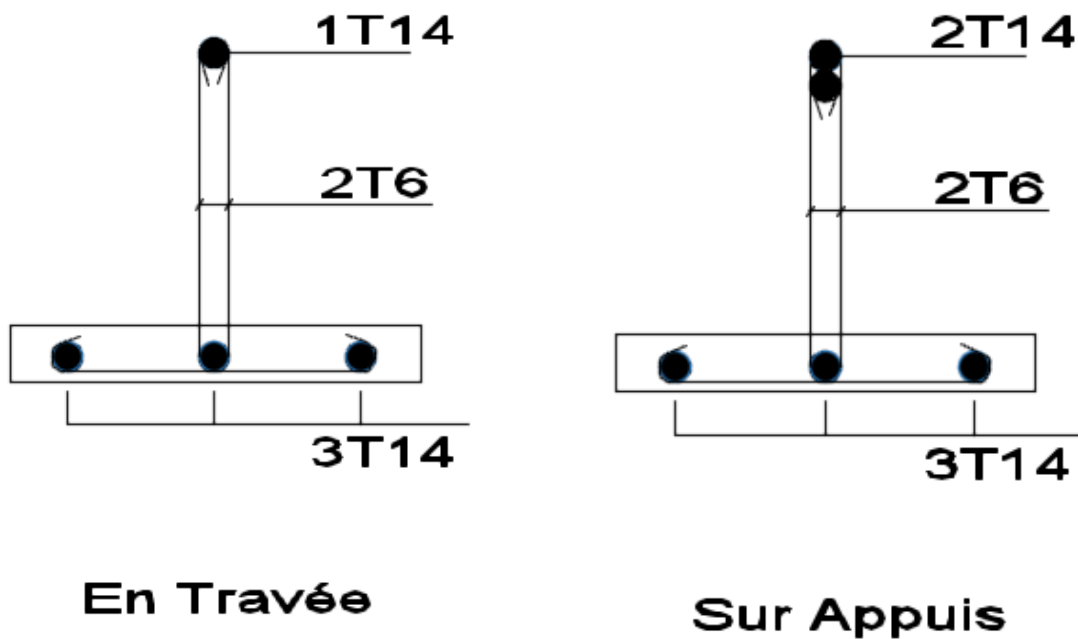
Ferrailage des poutrelles en travée, et en appuis.
